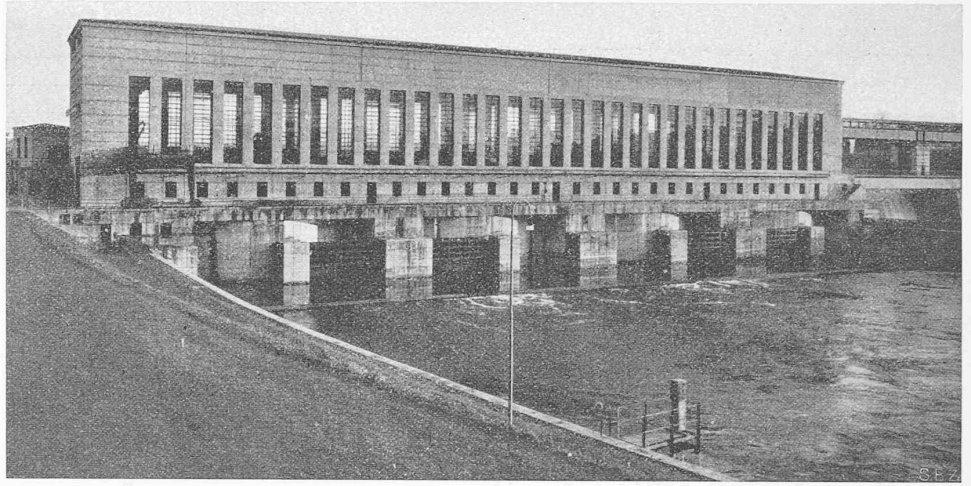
Unterwasserseitige Ansicht des Maschinenhauses, vom badischen Ufer aus gesehen.
